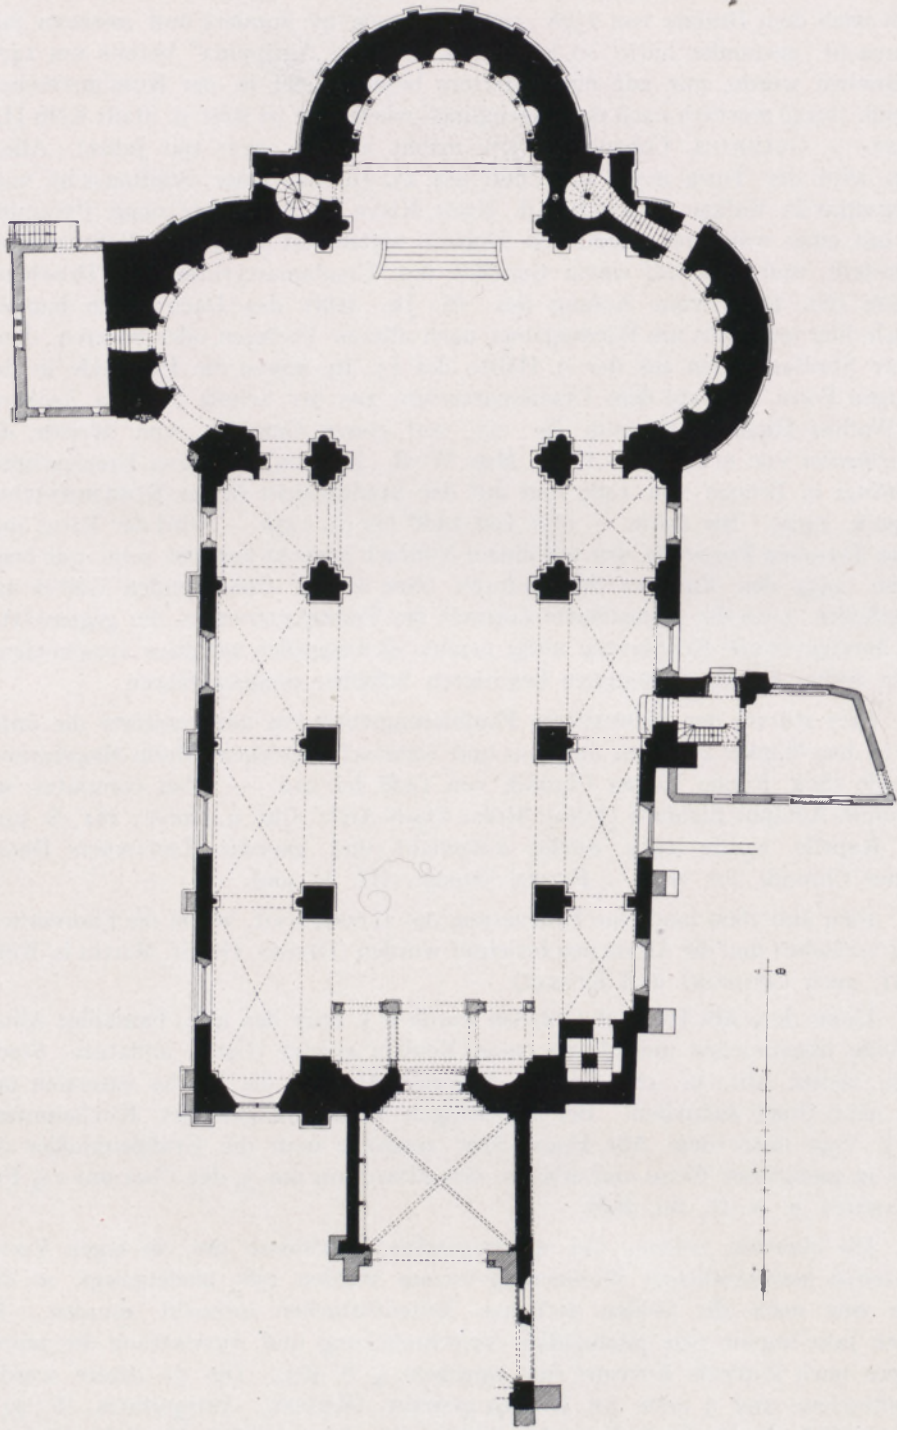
Gross St. Martin. Erdgeschossgrundriss.
